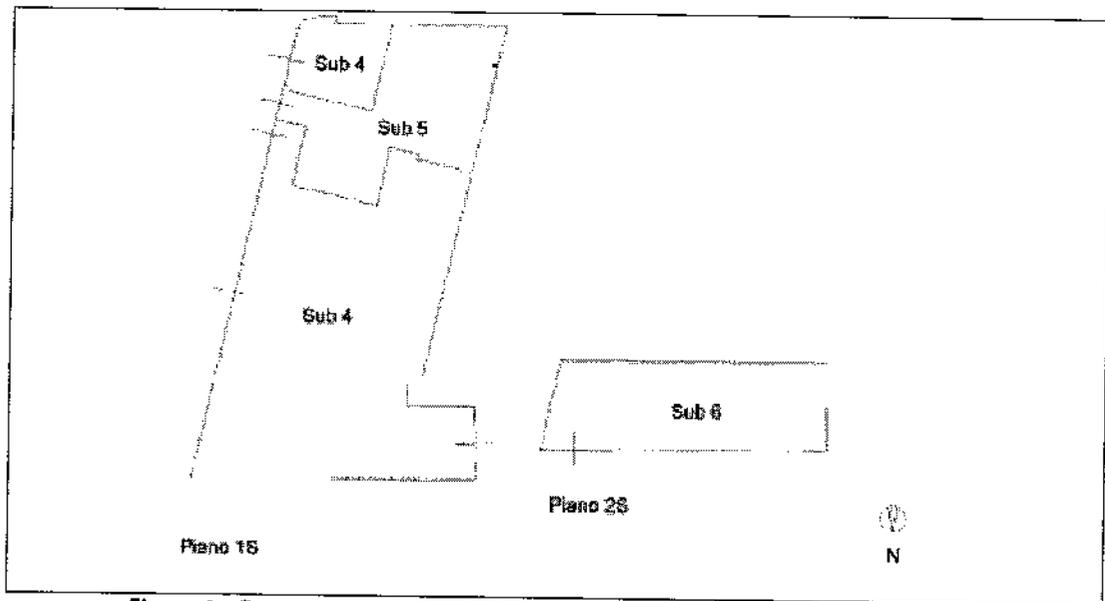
Rappresentazione subaltrni 4,5,6 (Elaborato Planimetrico catastale)
